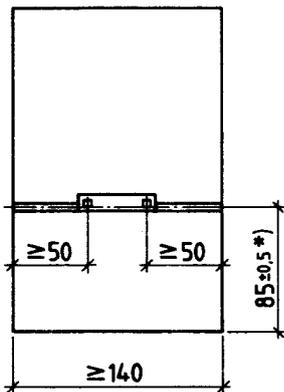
Höhenlage und Ansicht des Bedienungstableaus
